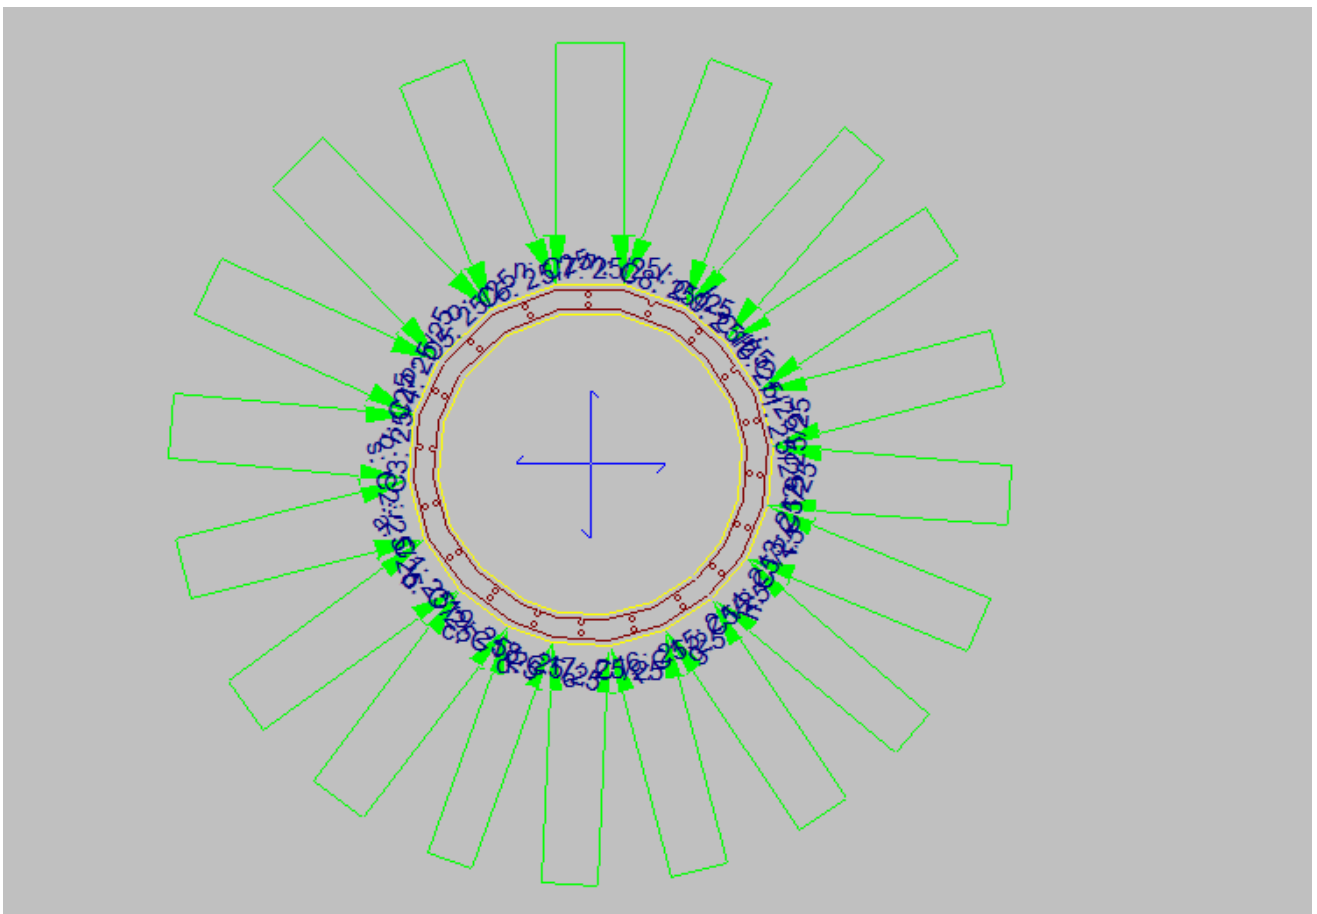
Lançamento dos carregamentos de empuxo nas paredes do modelo estrutural - Planta
